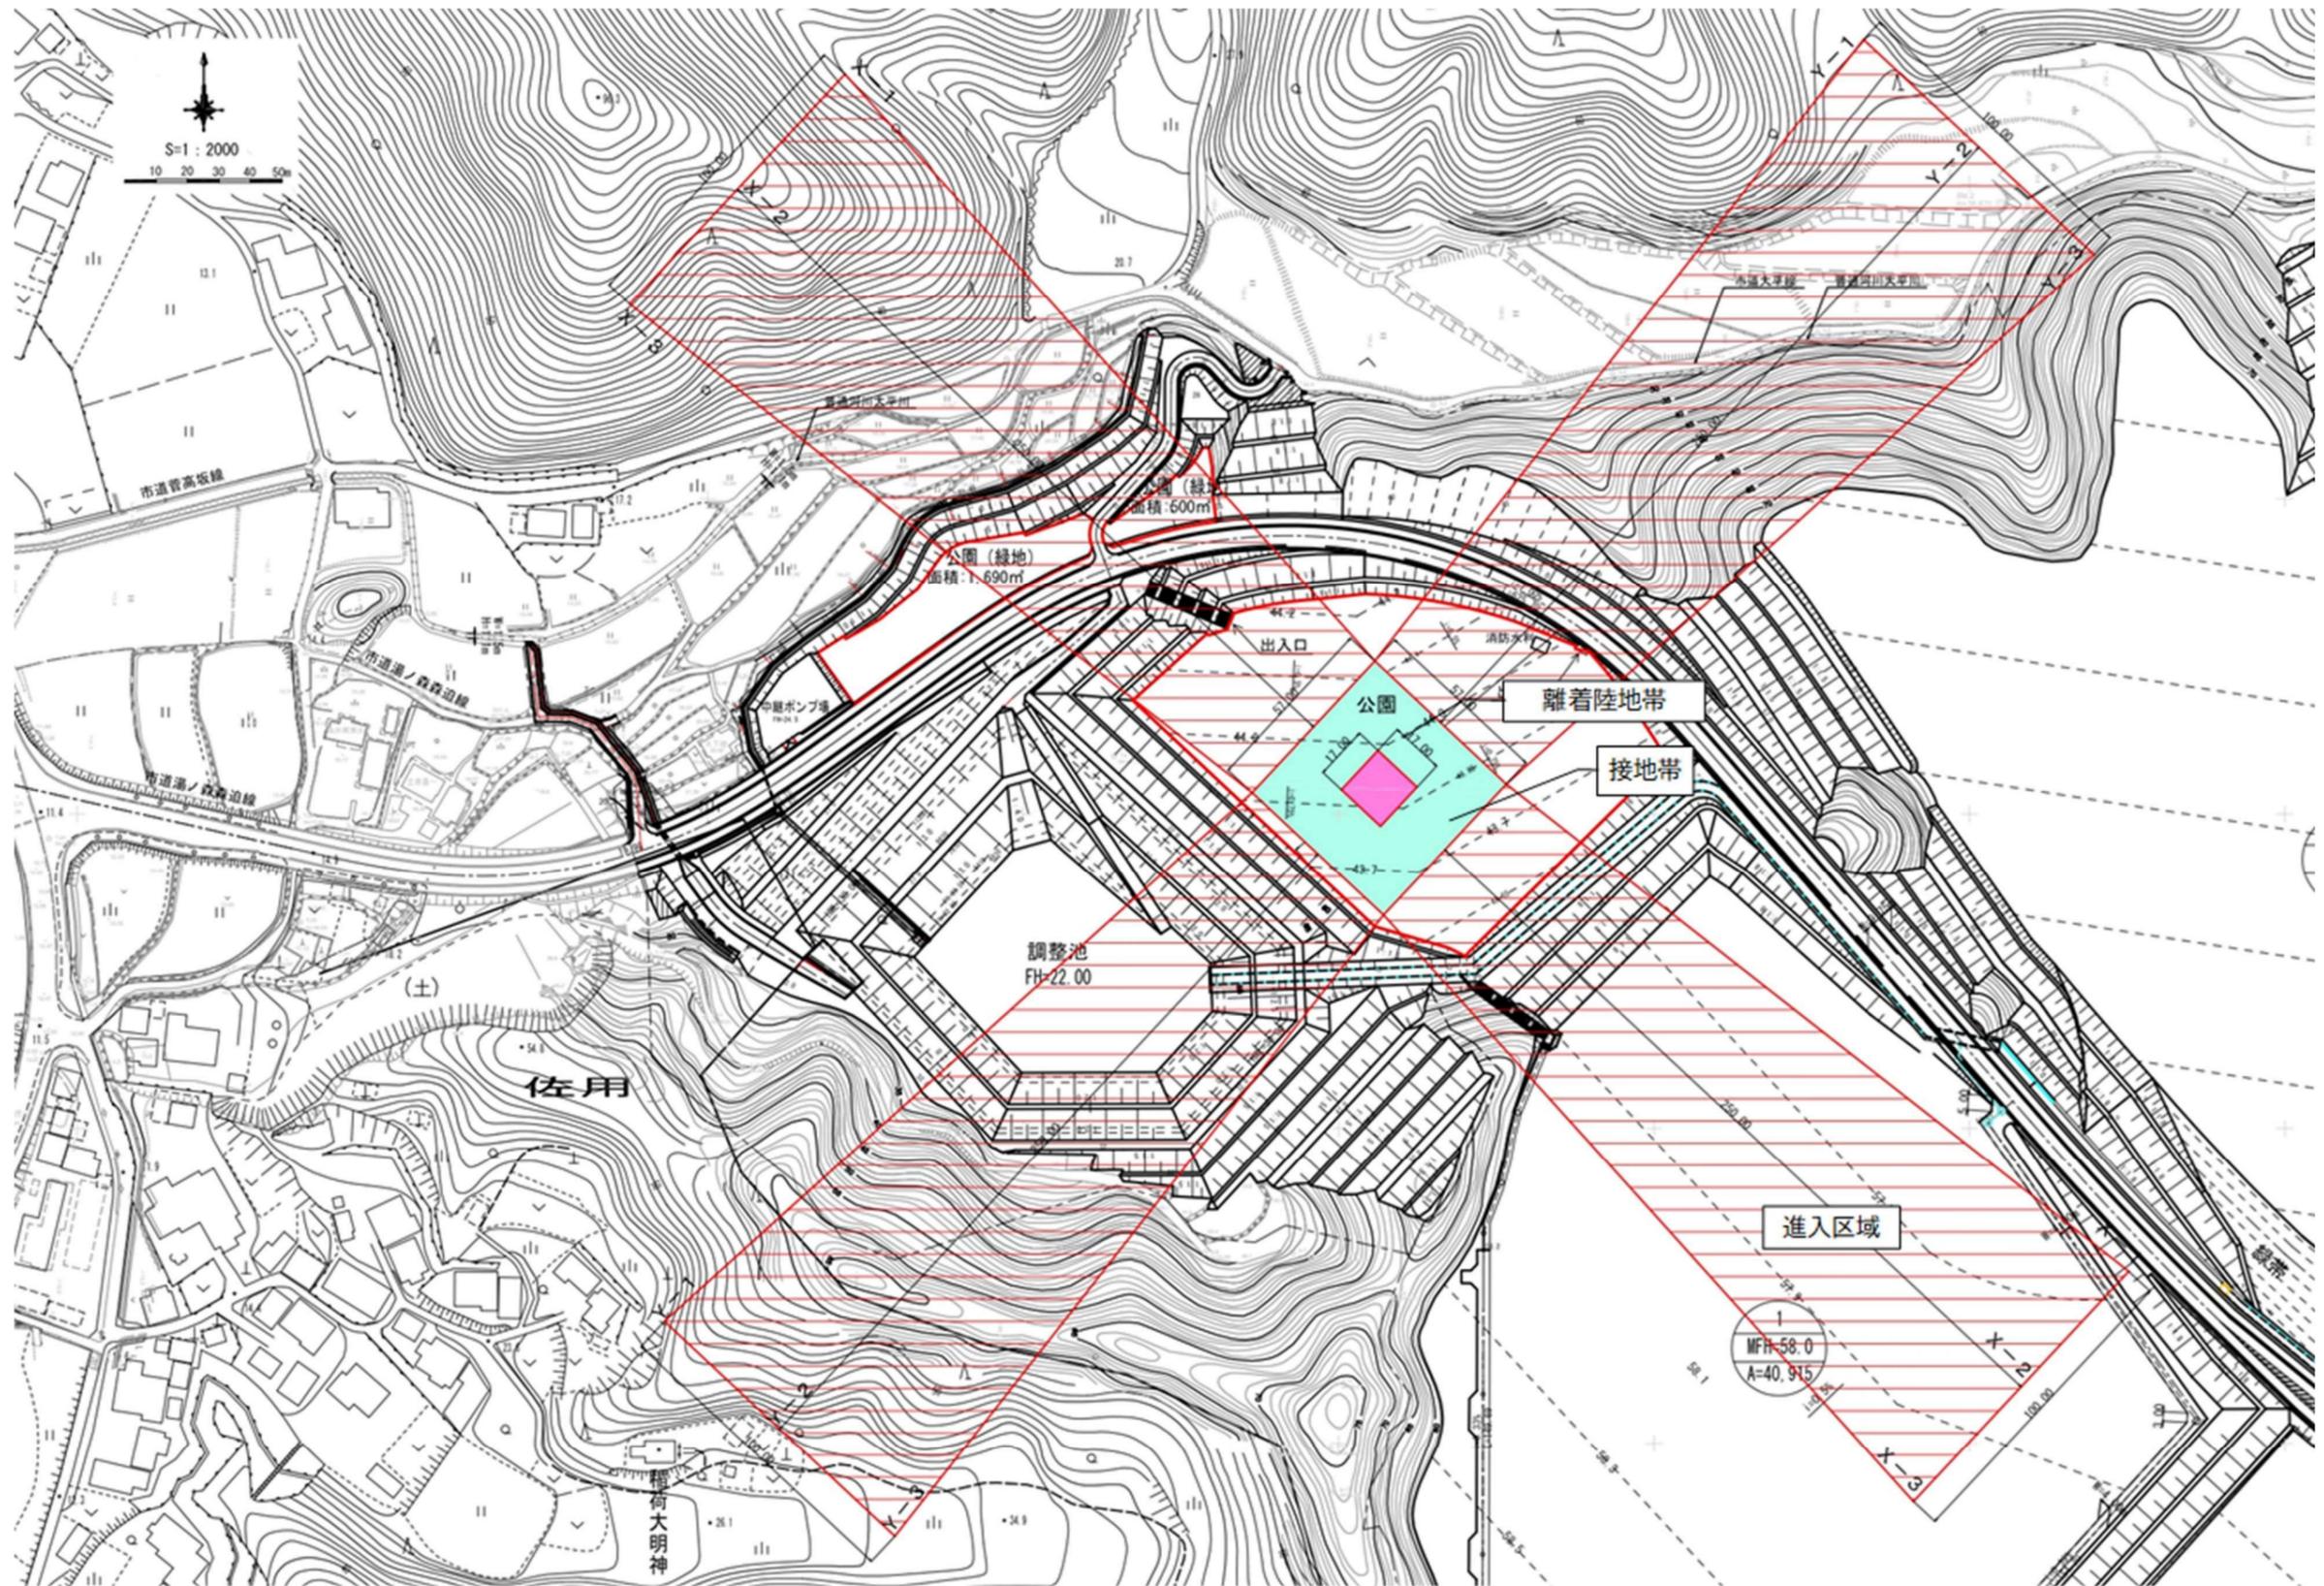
離着陸地帯、進入区域平面図 (S=1:2,000)
